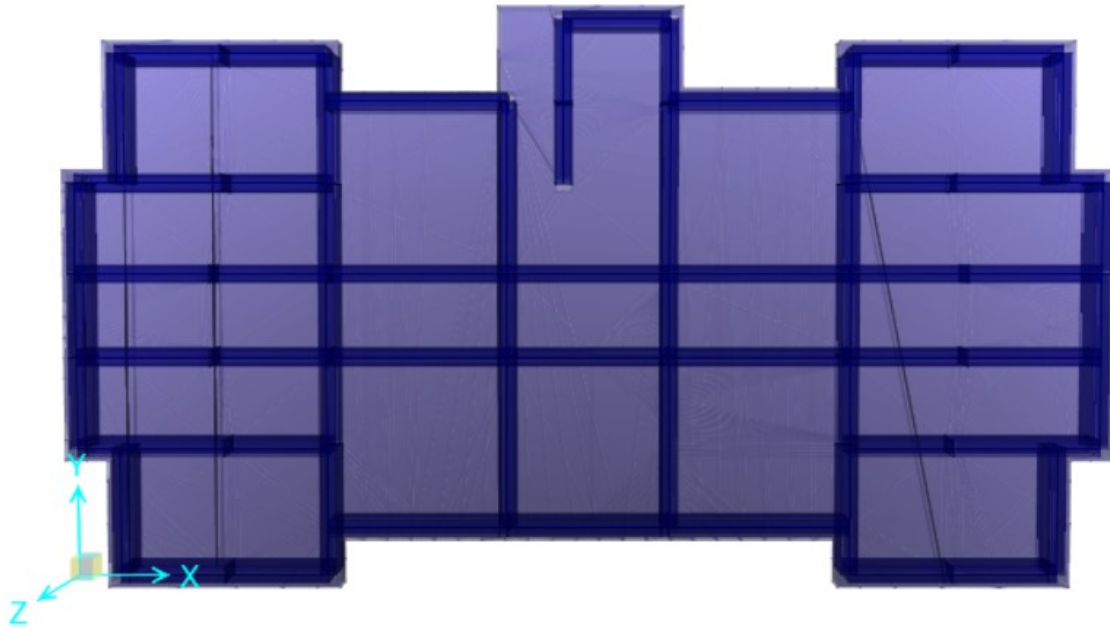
Disposición de elementos estructurales en la cimentación (Vista Planta) Sistema Dual - Edificio Blesser. Fuente: Elaboración Propia.
